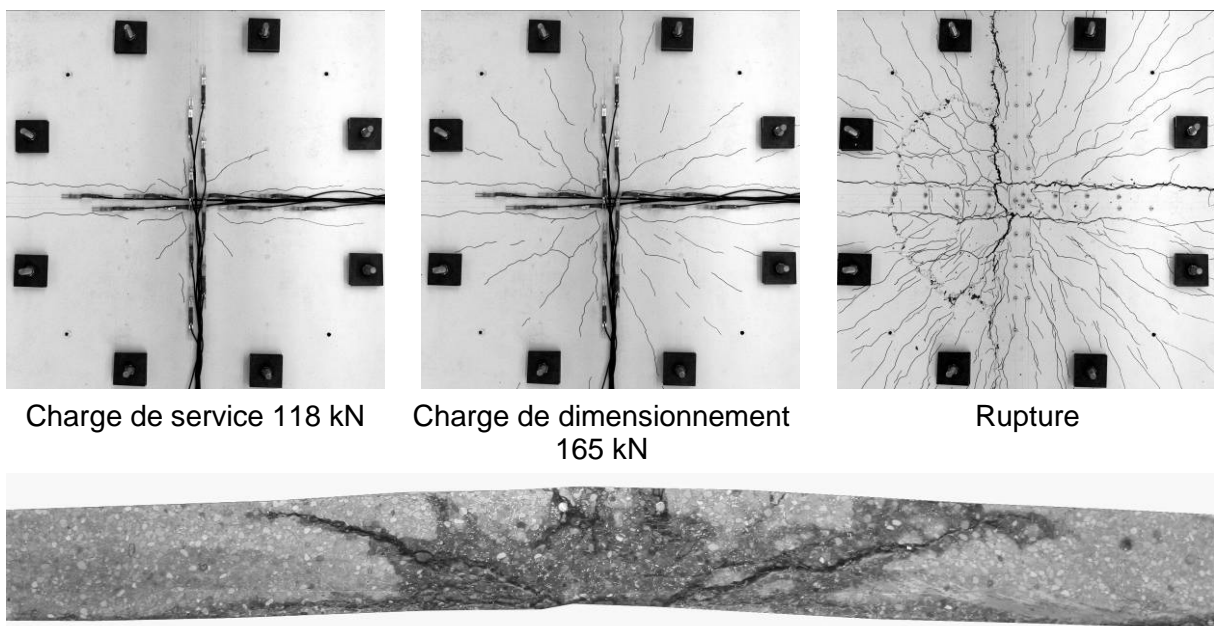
Fissuration à plusieurs niveaux de charge et fissures internes de la dalle B5-05.
